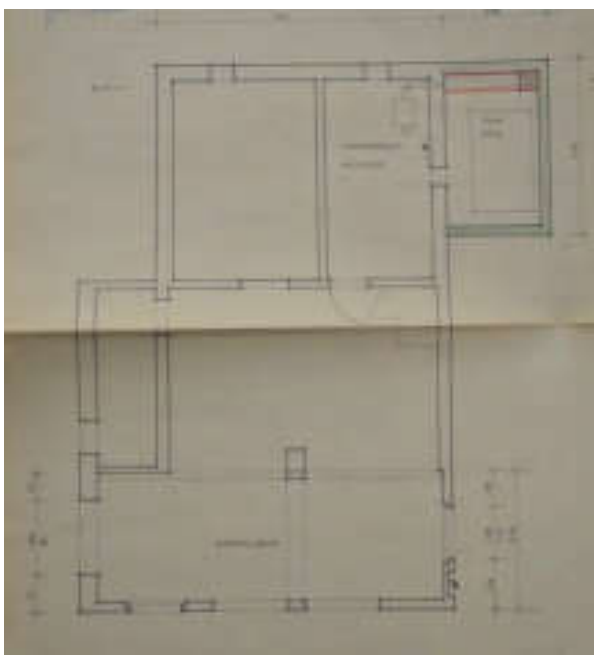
Ausführungsplan Wohnhaus Assek.-Nr. 253, Grundriss Untergeschoss 1:50, Pinggera Bauführungen Dietlikon. Quelle: GdeA.
